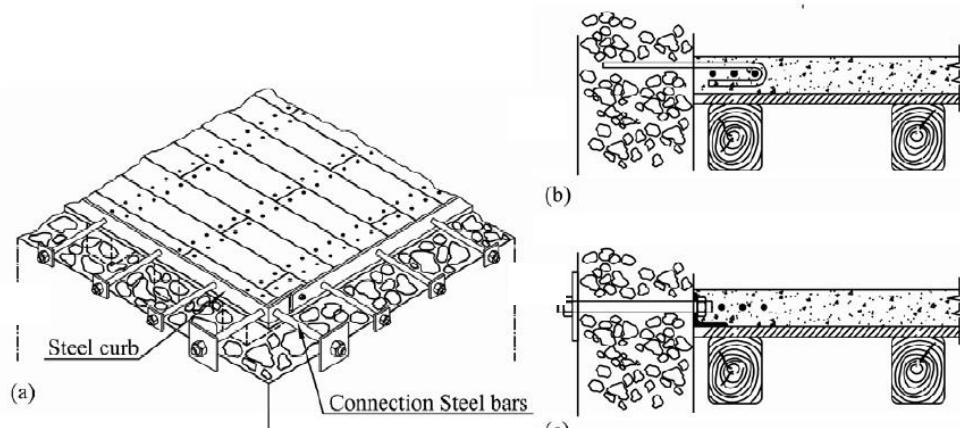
Elementos de ligação entre o diafragma e a parede de alvenaria - adaptado de (Piazza, Baldessari e Tomasi, 2008)
